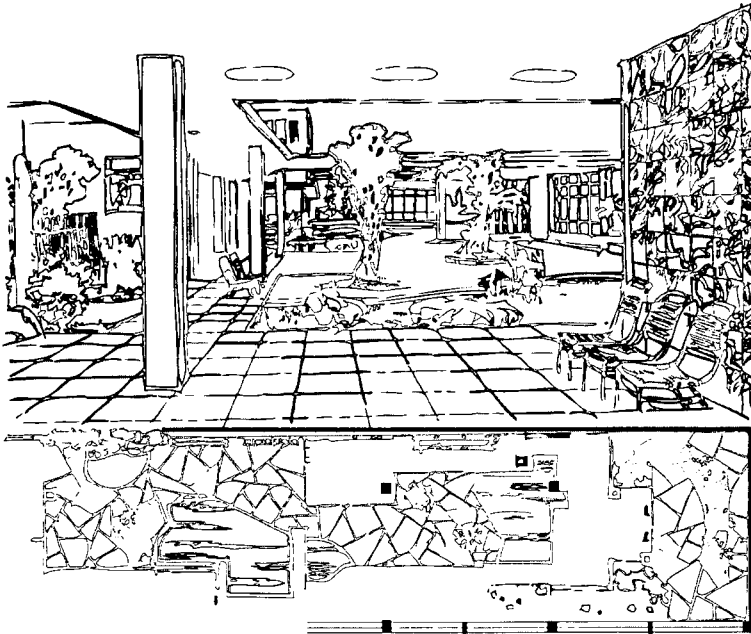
Зимовий сад в холі громадської будівлі
